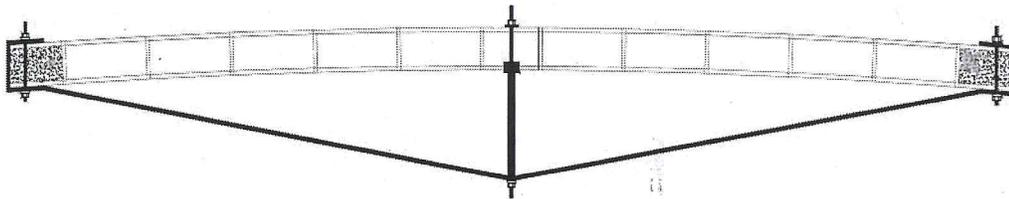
Vista longitudinal de una viga compuesta presforzada.
